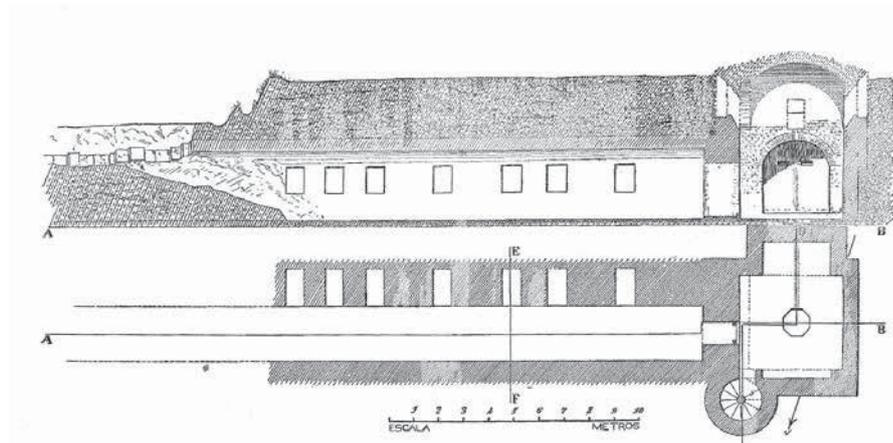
Detalle del criptopórtico, alzado y planta realizados por Juan Cabré (1923).
